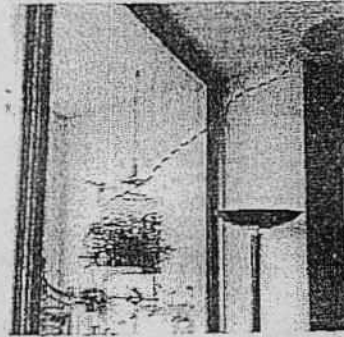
Grietas en muros interiores apartamento 501 torre costado norte.
